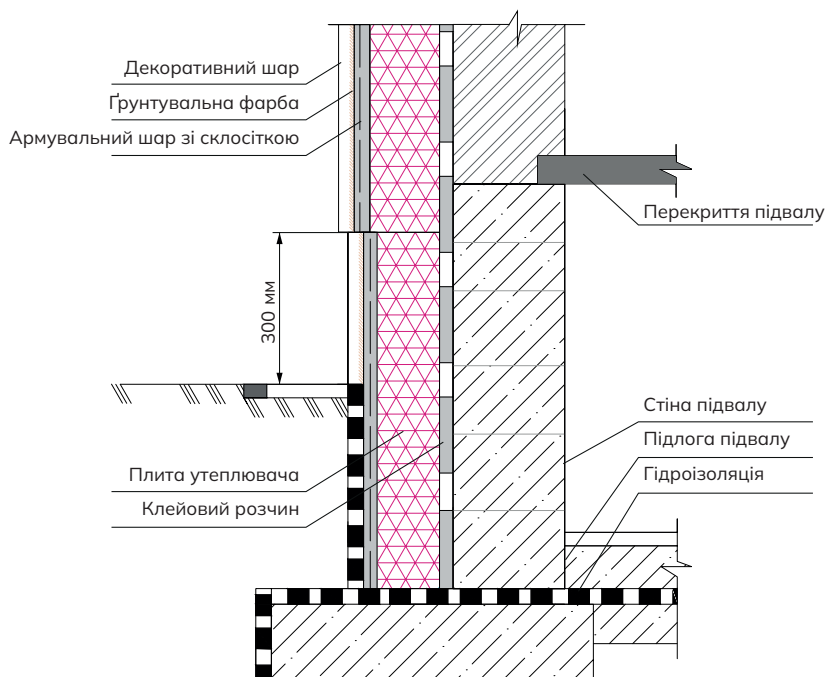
Утеплення стіни з утепленням підвальної частини будівлі
